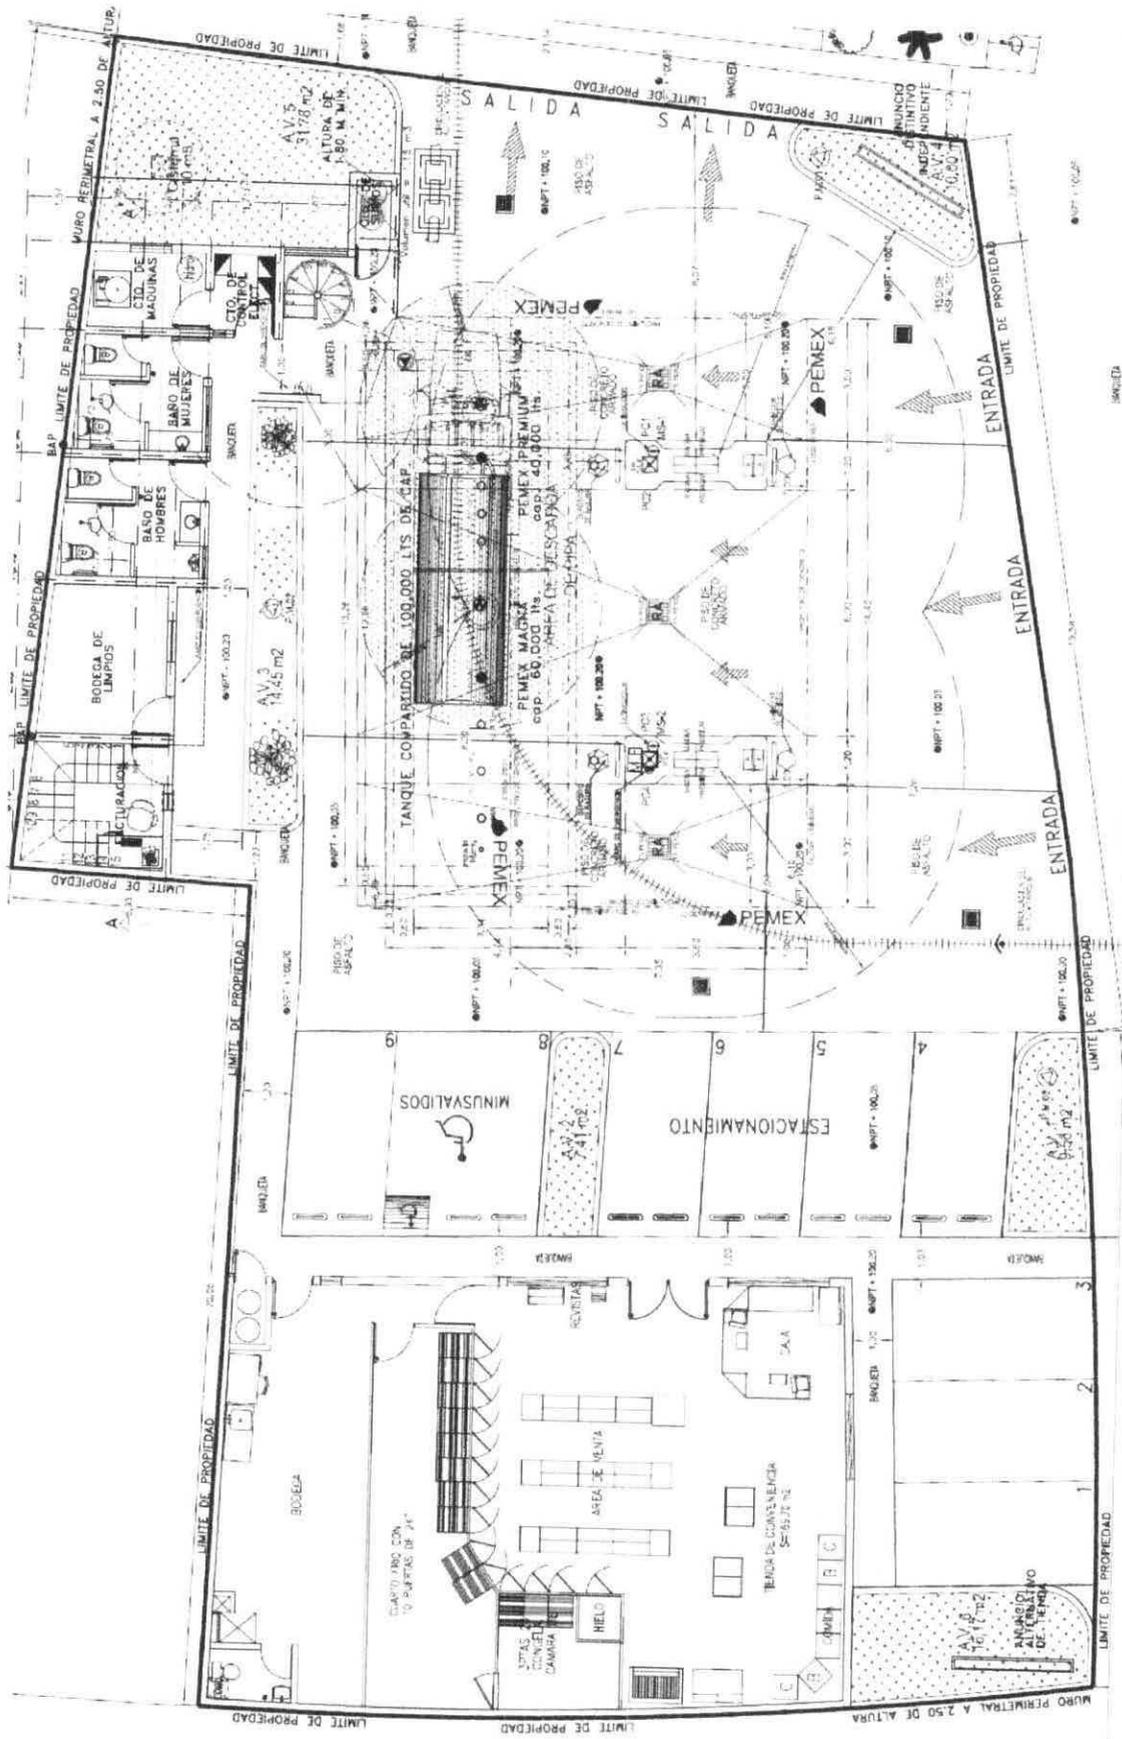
1. Infraestructura necesaria para la operación del proyecto. Plano conjunto A-1
